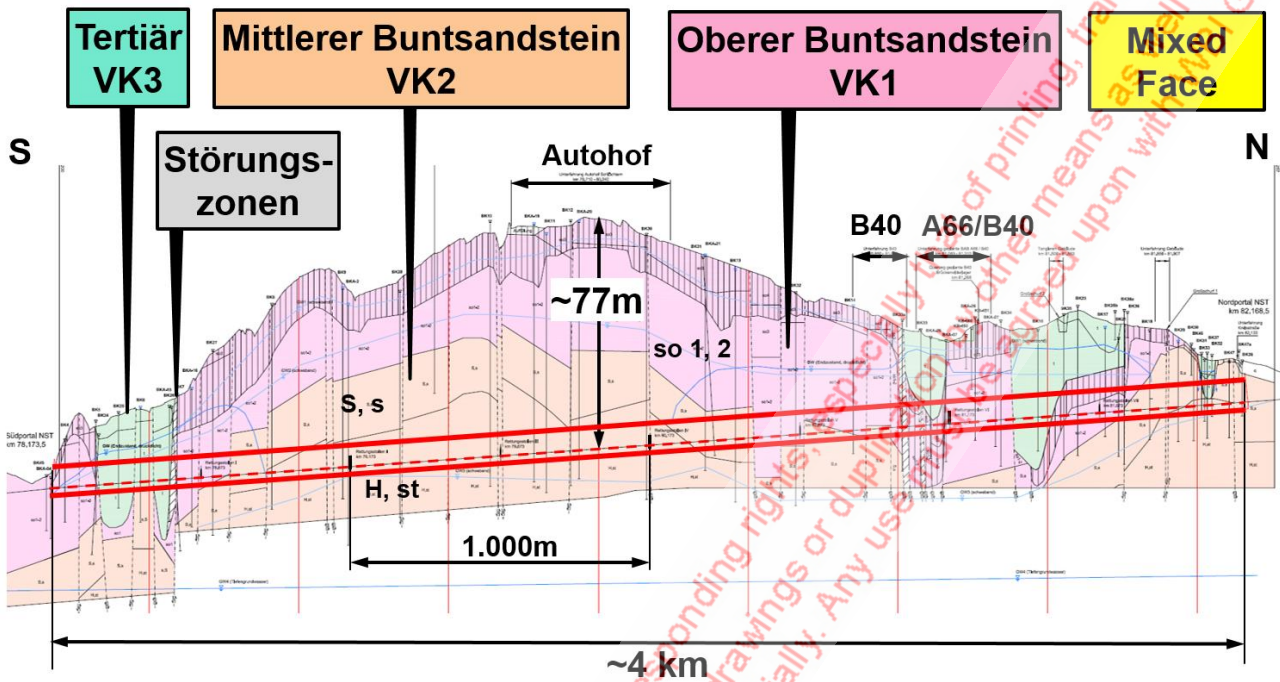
Tunnelbautechnischer Längsschnitt (GTB Olpe 2002)
